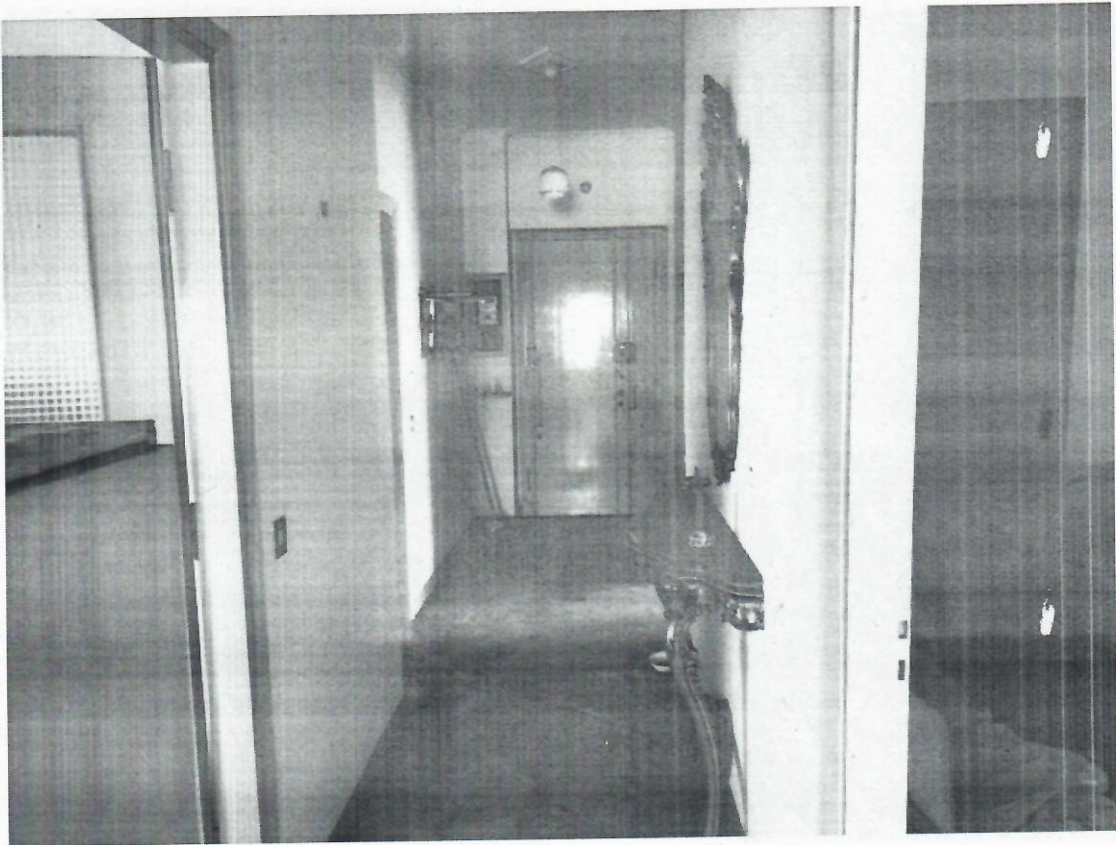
alloggio – piano secondo – ingresso/corridoio
